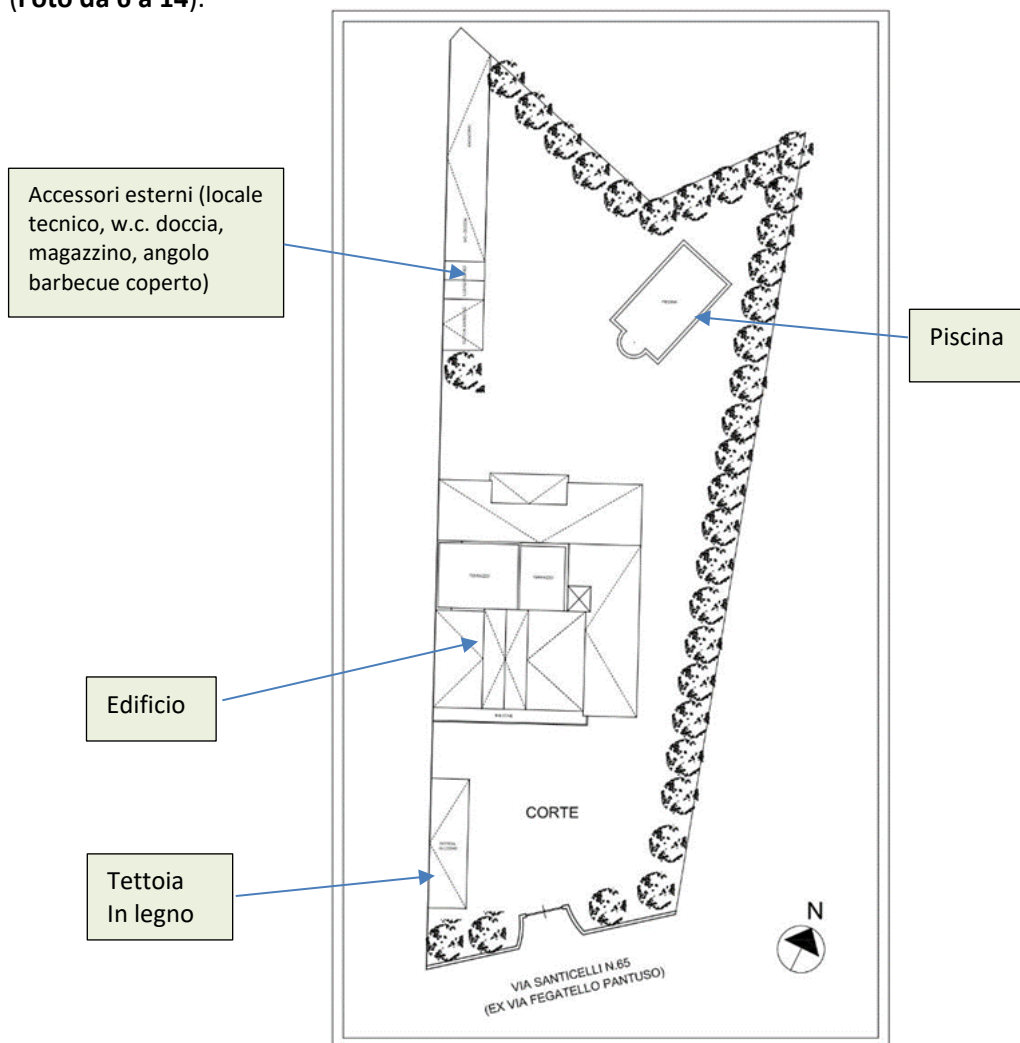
Rilievo planimetrico del lotto pignorato alla data del sopralluogo
